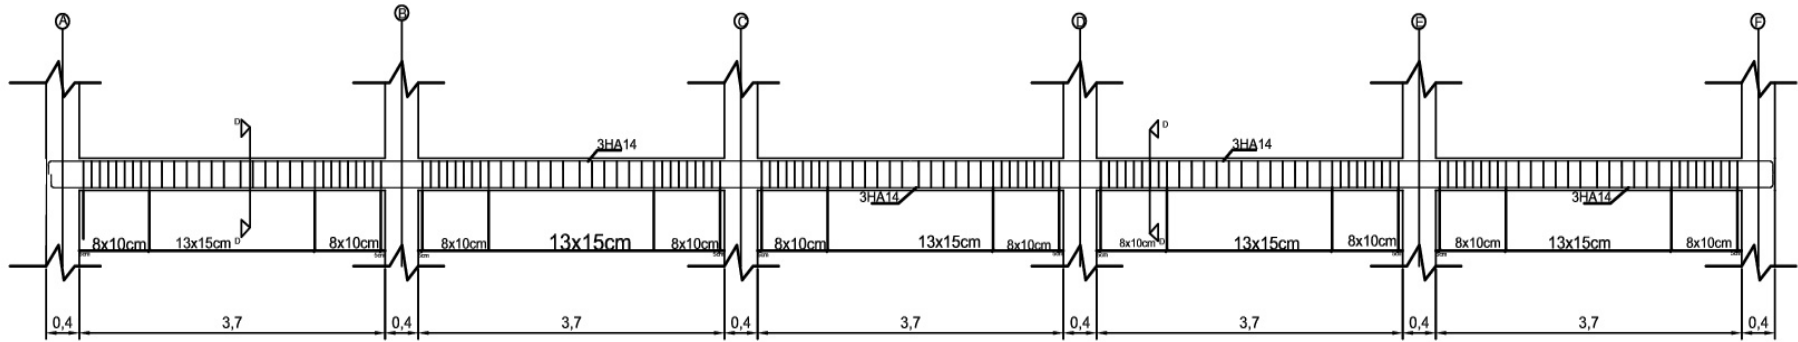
Plan de ferrailage des poutres principales.( PPNLV)
